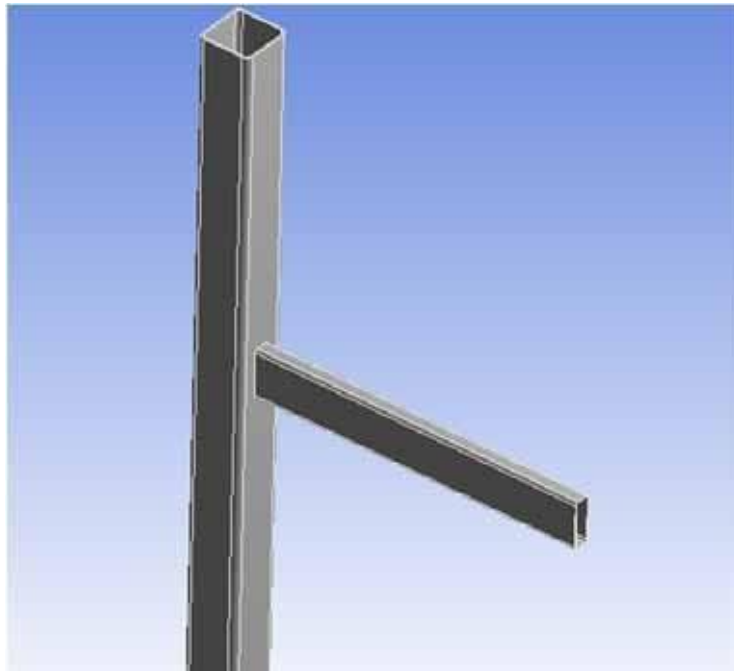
Conexión soldada directa entre perfiles tubulares sin elementos de refuerzo
